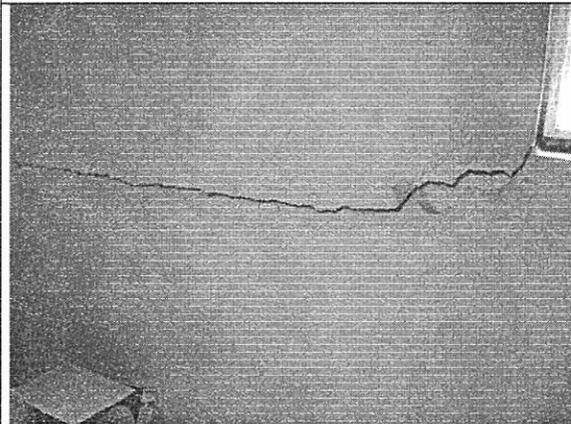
Agrietamiento del muro de fachada, cara interna.
